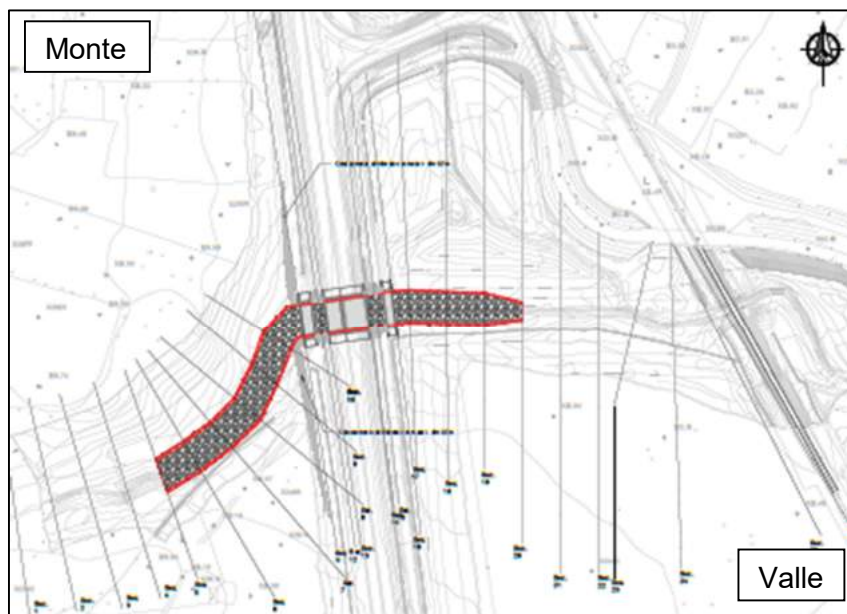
Stralcio planimetrico di inquadramento dell'attraversamento sul Riu Bonorchis tramite ponticello idraulico
